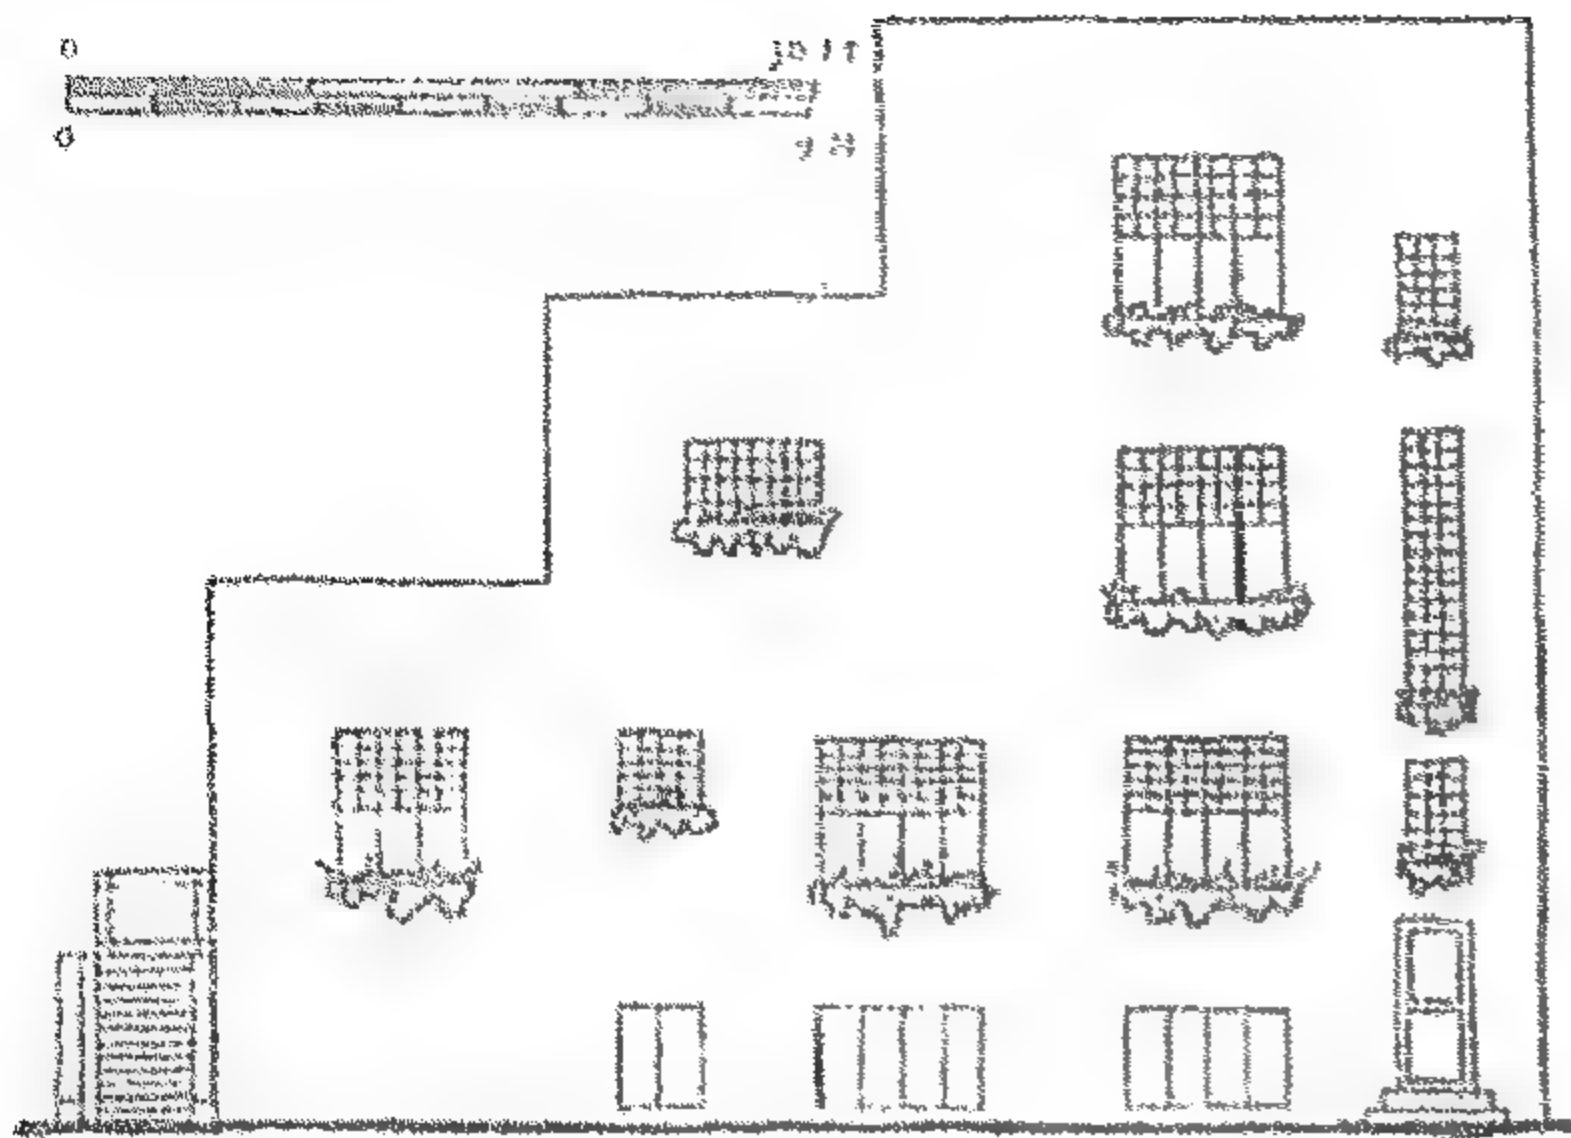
3) منزل شتاينر 1910 Steiner House
